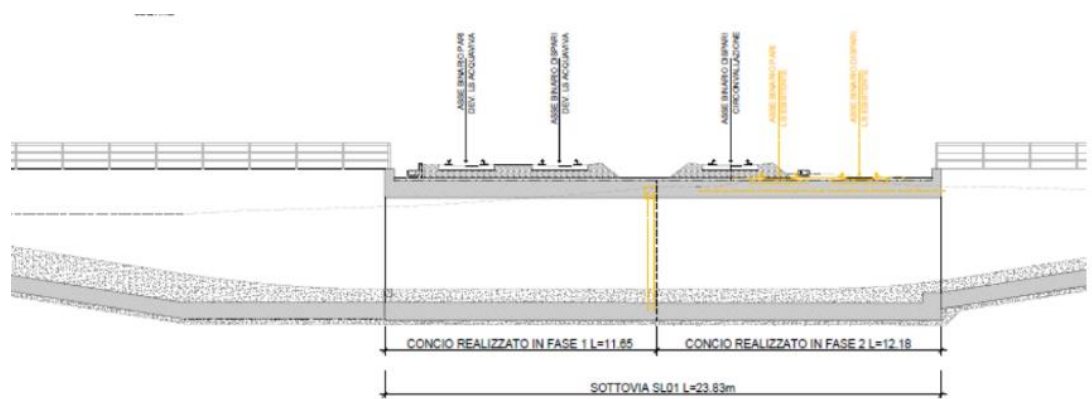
Sezione longitudinale fase A+B sottovia SL01
